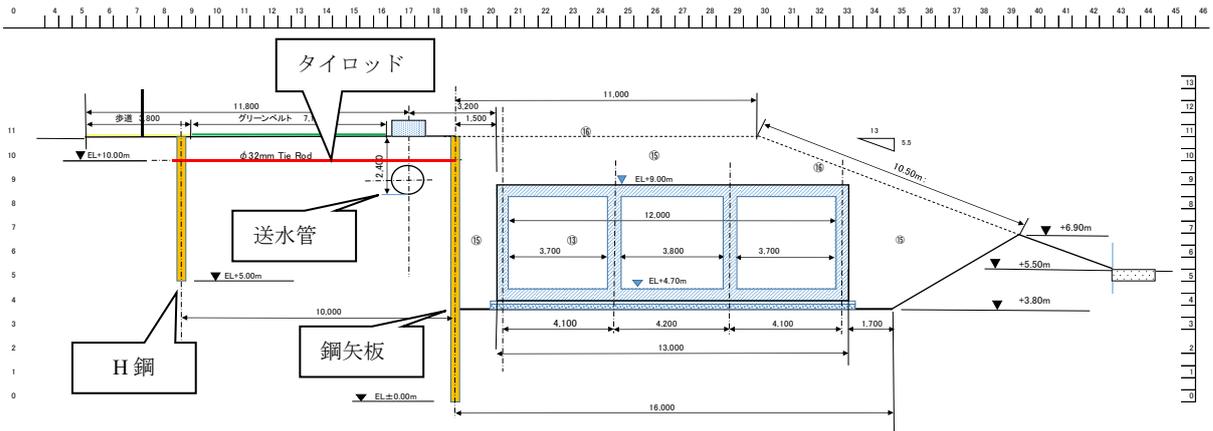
6号地下貯留槽の施工断面標準図
